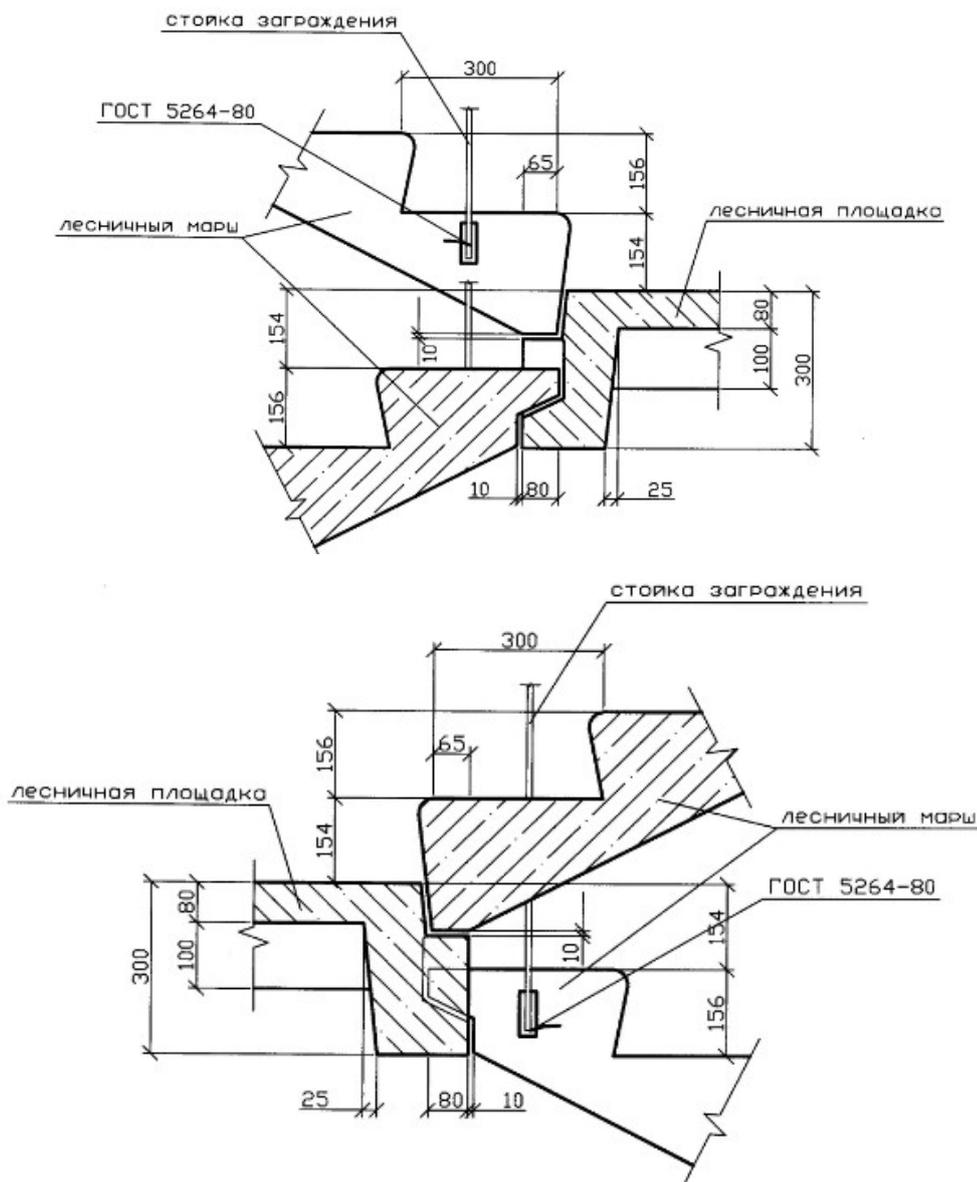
Узлы сопряжения сборной железобетонной лестничной площадки и сборного железобетонного лестничного марша плитной конструкции.
